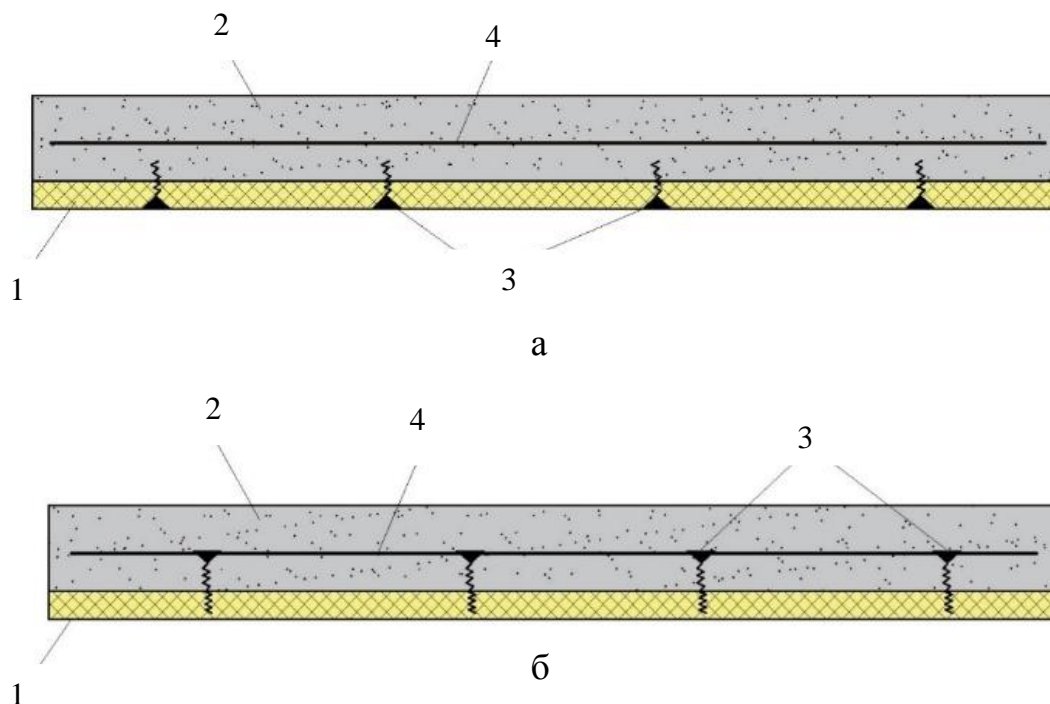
Конструктивные схемы сборной двухслойной дорожной плиты: крепление полимеркомпозитной плиты анкерами-саморезами с бетонным слоем известным способом (а); то же по новому способу (б); 1 – нижняя полимеркомпозитная плита; 2 – бетонный слой; 3 – анкера-саморезы; 4 – полимеркомпозитная сетка
